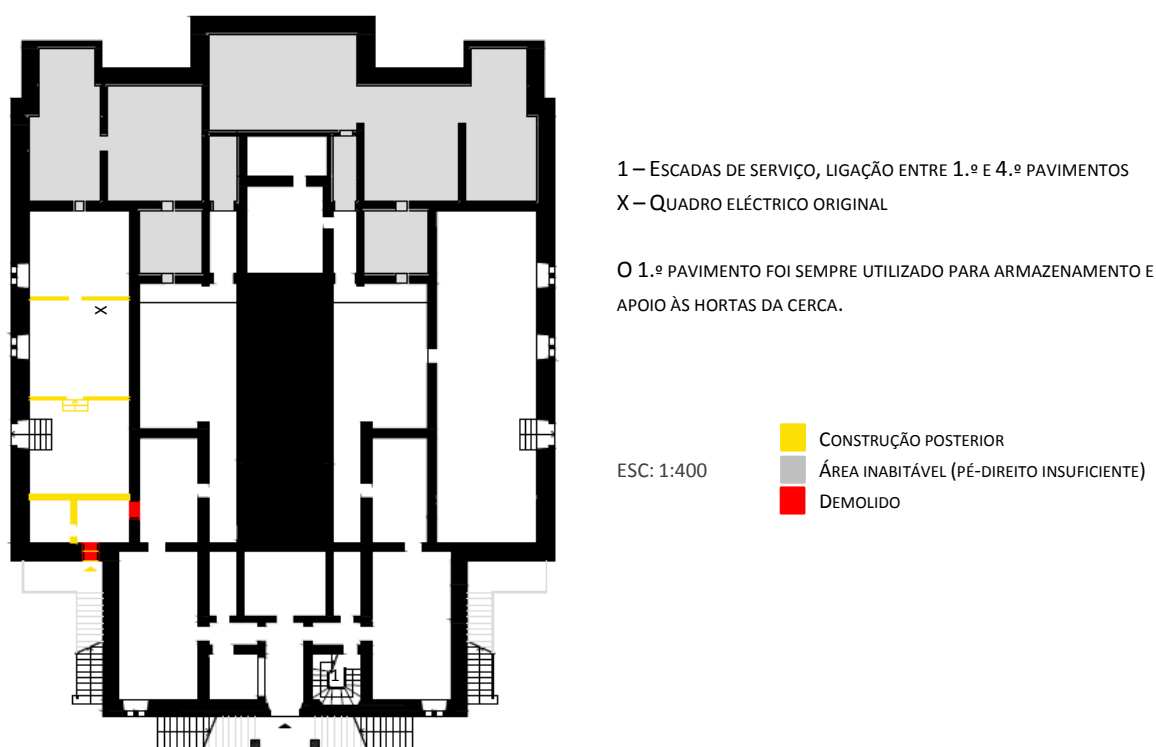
Proposta de reconstituição do 1.º pavimento, em 1916
